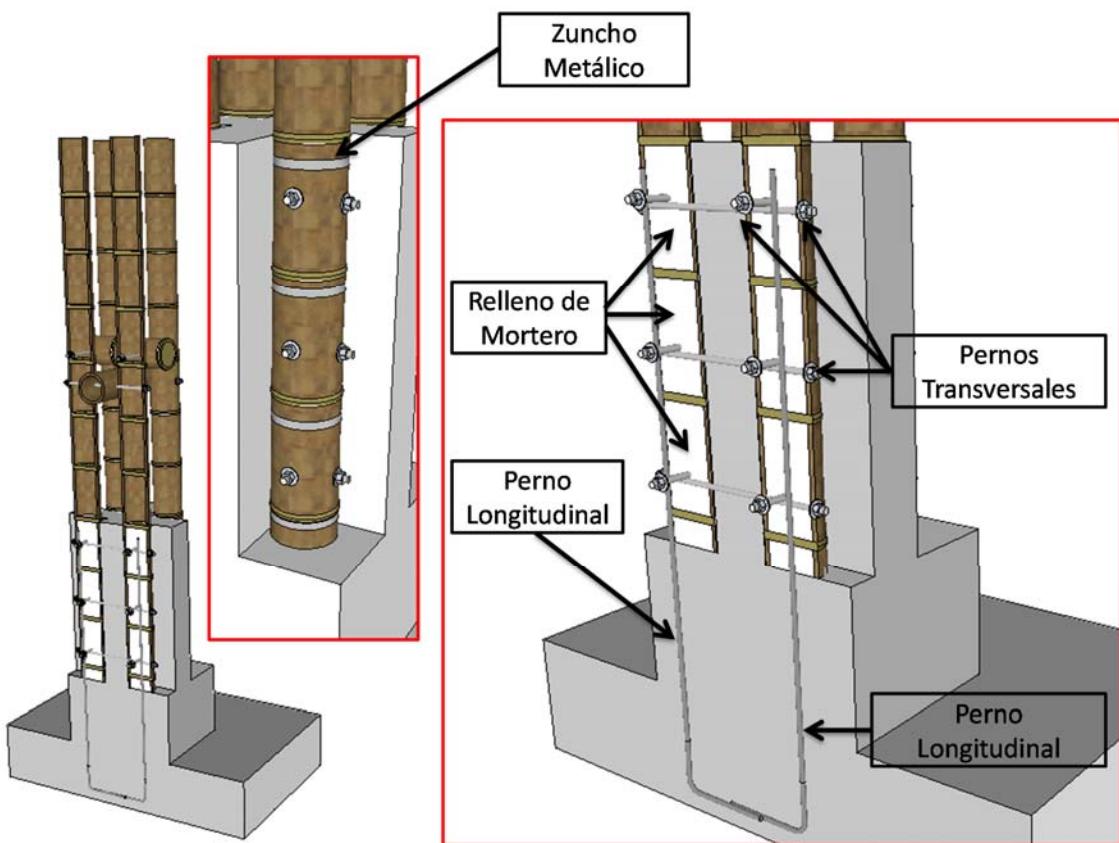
Detalle de la conexión entre la columna de guadua y el pedestal de concreto reforzado.
